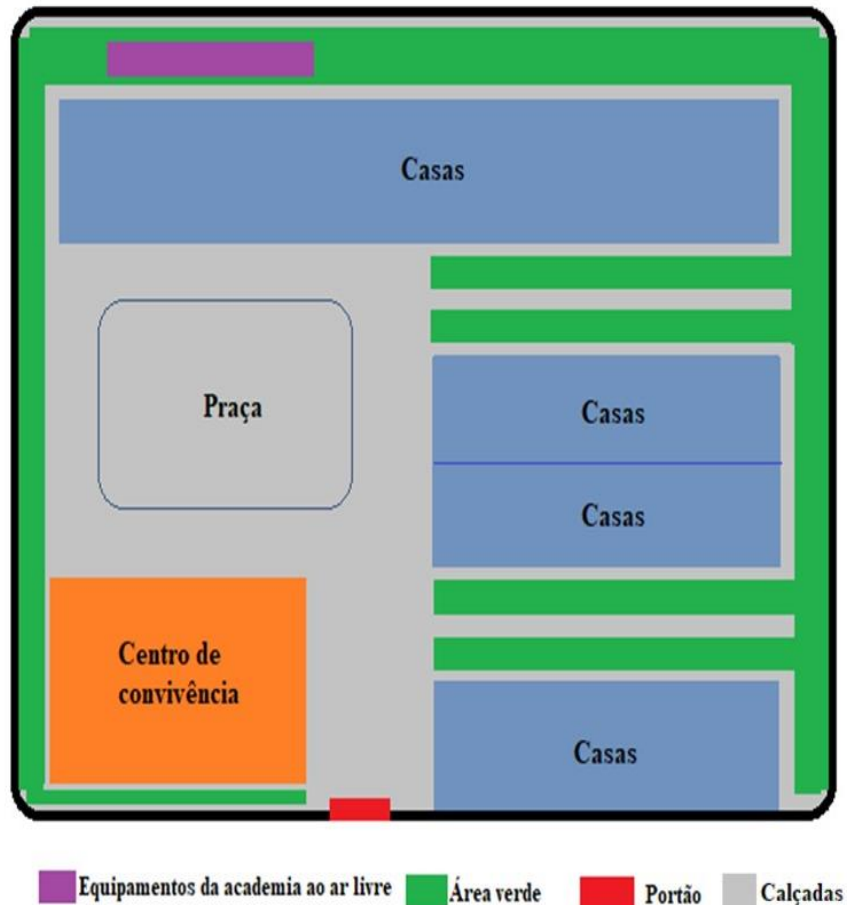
disposição das casas e centro de convivência do Recanto Feliz
